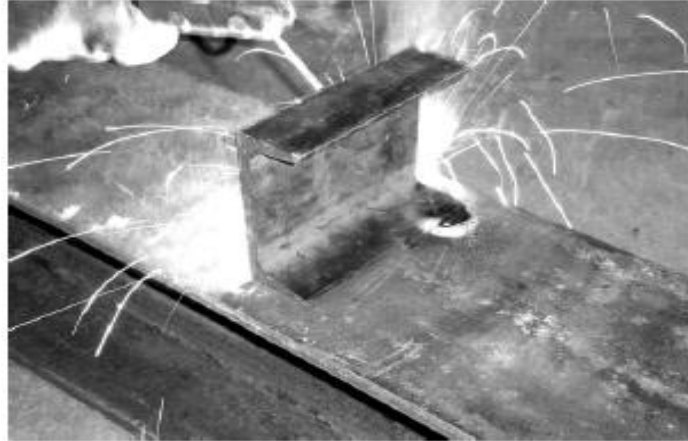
connecteur de cisaillement de la Manche a soudé pour rayonner la semelle. [1]
